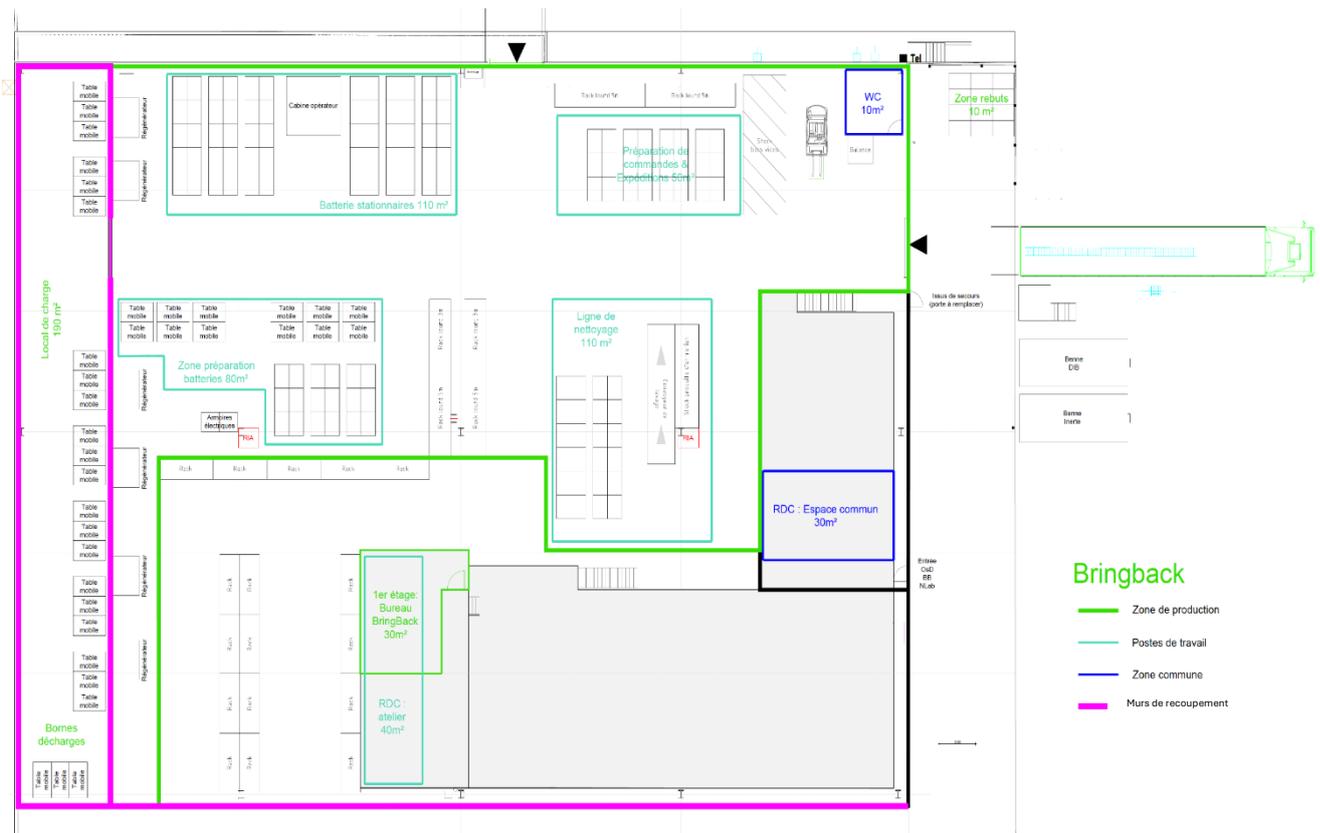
plan d'implantation du projet sur le lot 1B (plan agrandi en page 22)
